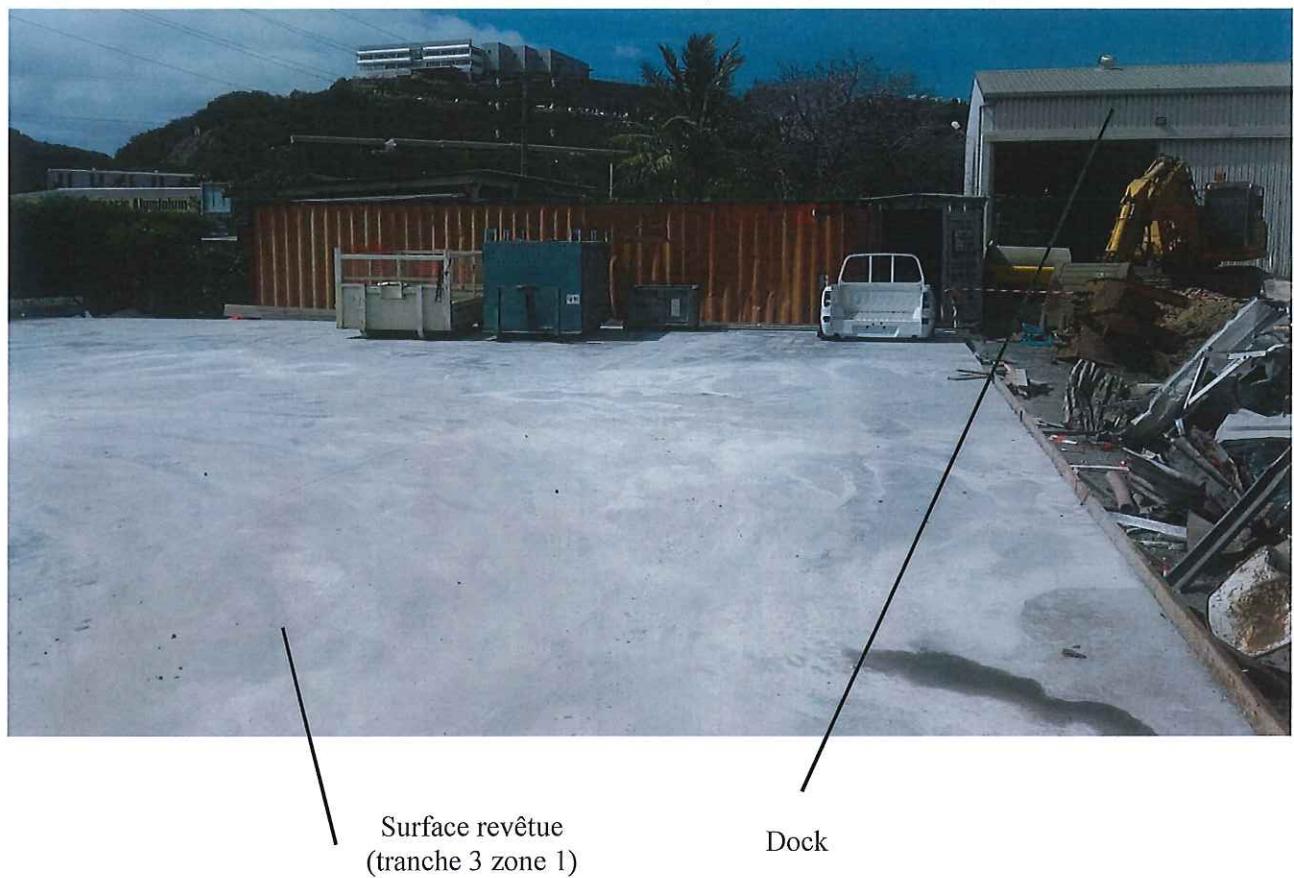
zone 2 de la tranche 3 en cours de terrassement (vue en direction de l'Est)
